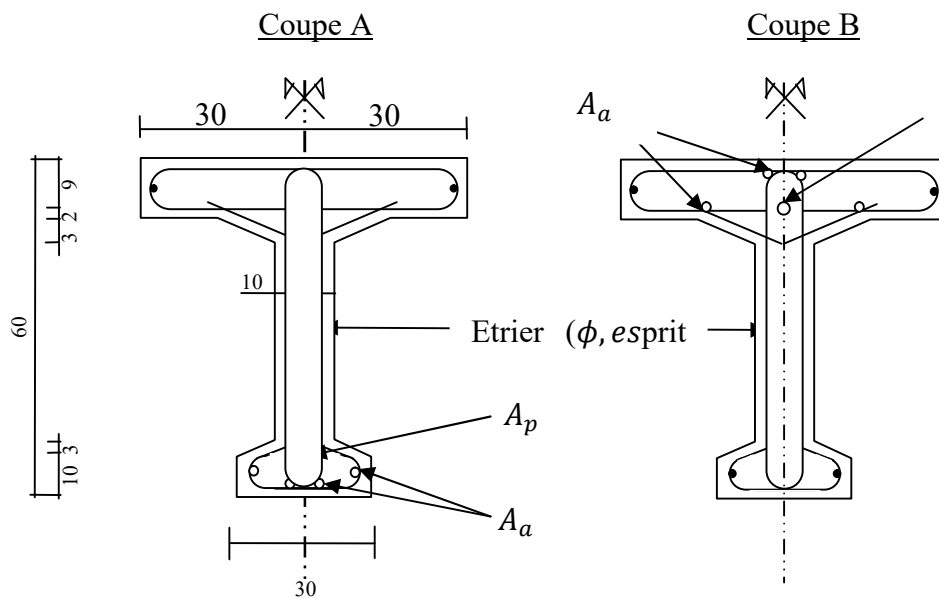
Dimension et détails de ferrailage des poutres HZ
